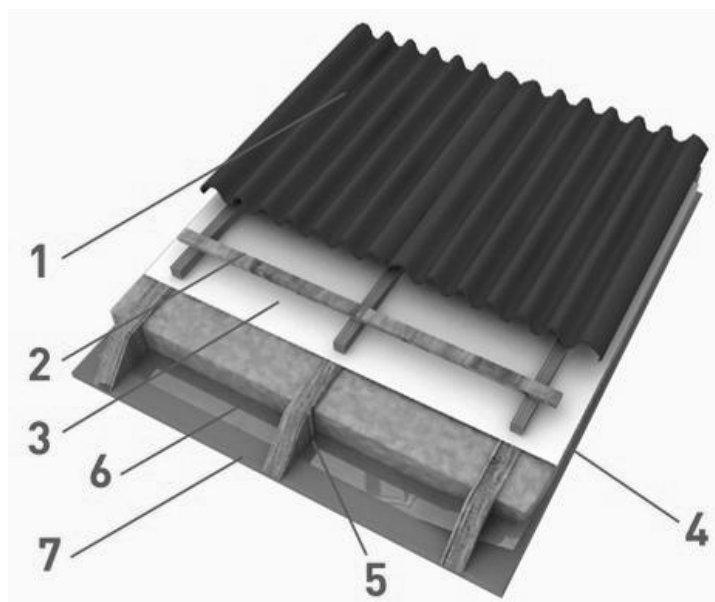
Структура скатной кровли: 1 – черепица или другой кровельный материал; 2 – шаговая (поперечная) обрешетка; 3 – ветро- и влагозащитная мембрана; 4 – слой утеплителя; 5 – стропила; 6 – слой пароизоляции; 7 – слой внутренней отделки
